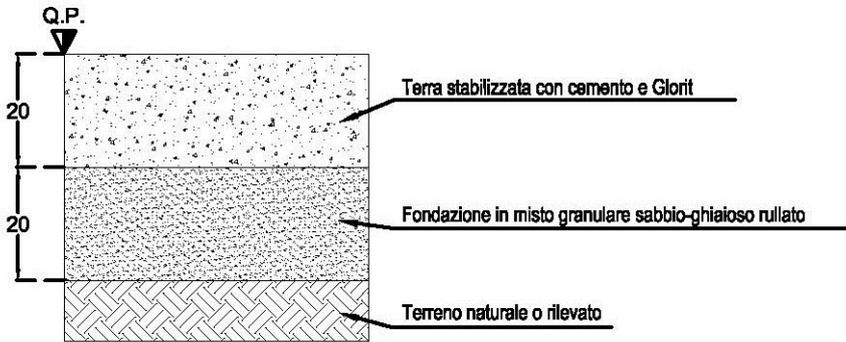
pacchetto di pavimentazione previsto per la strada bianca di accesso alla stazione elettrica di Lesegno
